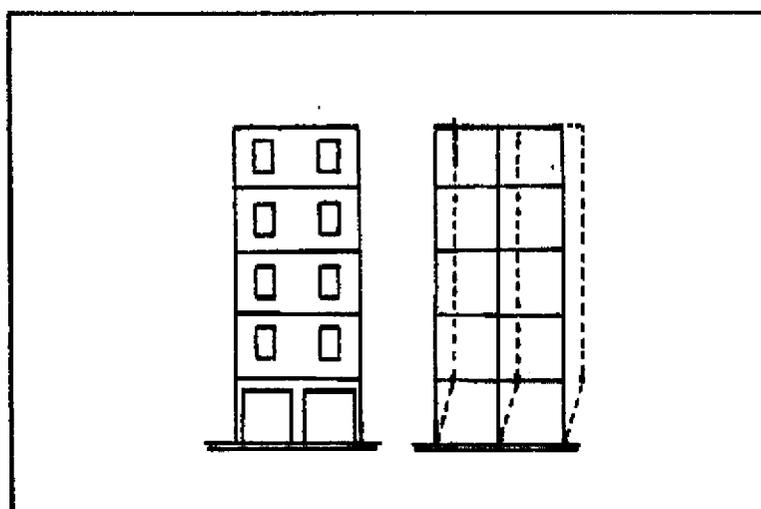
Edificio con planta baja flexible y pisos superiores rigidizados por mampostería. La energía sísmica es disipada por deformación de las columnas de la planta baja, pudiendo conducir a un mecanismo de colapso.
